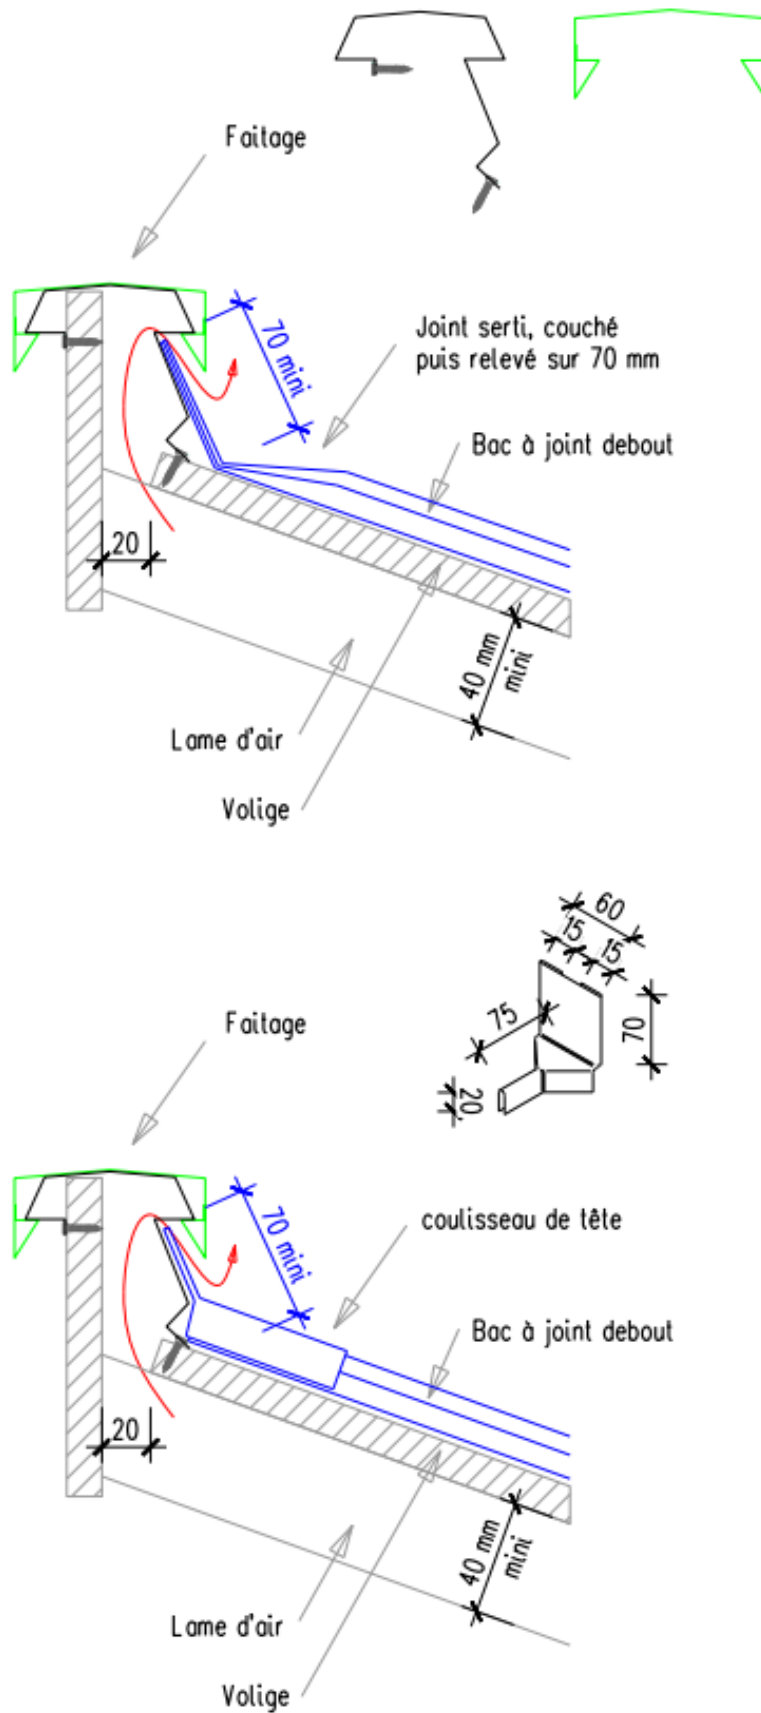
Exemple de faitage en butée contre un mur avec coulisseau (pente ≥ 5) avec coulisseau de tête ou joint couché
